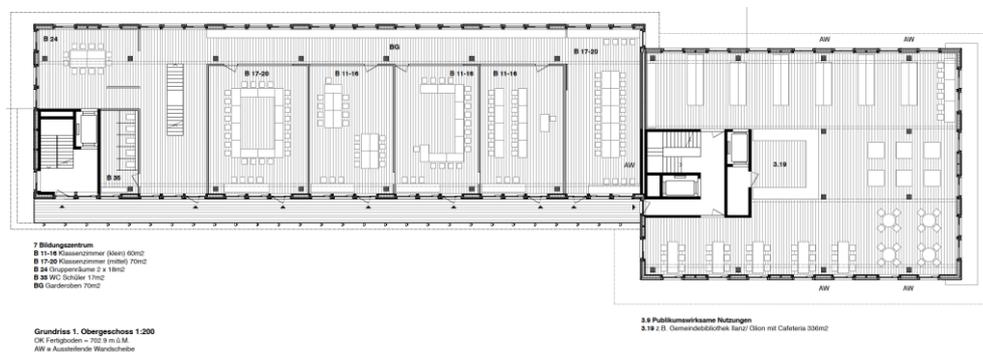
Grundriss 1. Obergeschoss «viadi»
